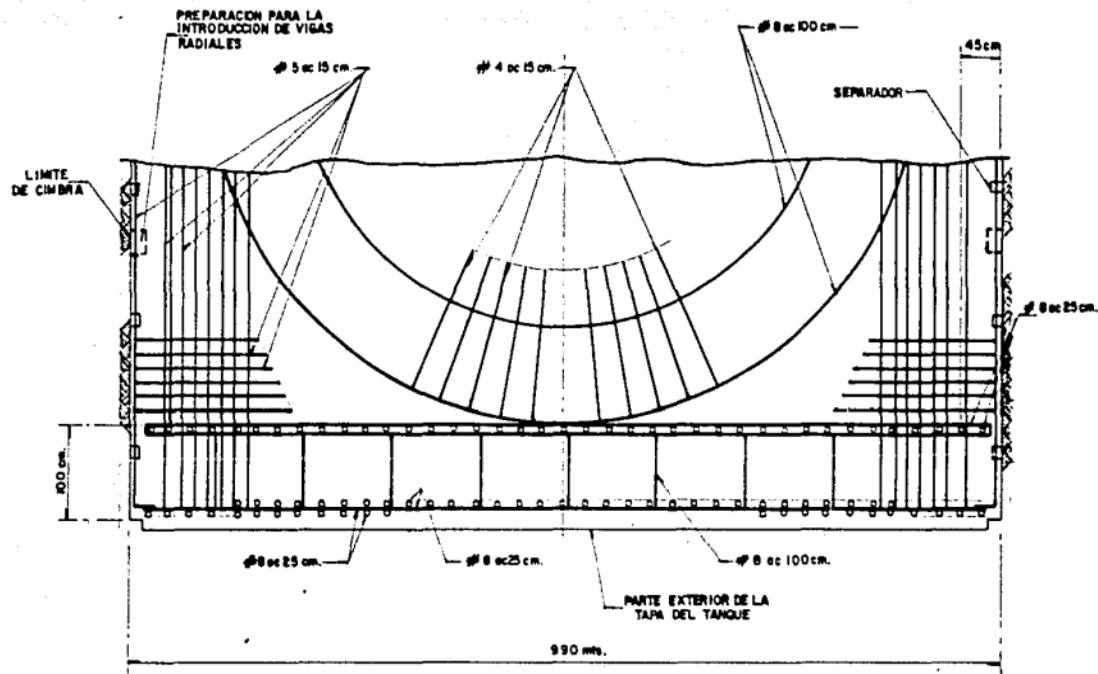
CORTE DE LA LOSA DEL PISO Y MURO DE LA LUMBRERA
